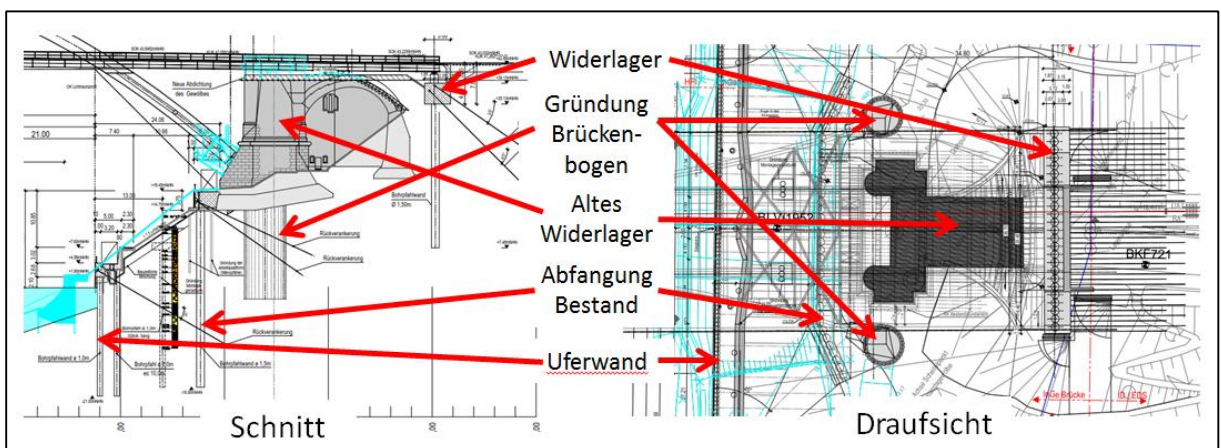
Gründungen im Bereich des südlichen Widerlagers (Plangrundlagen aus /U2/)
